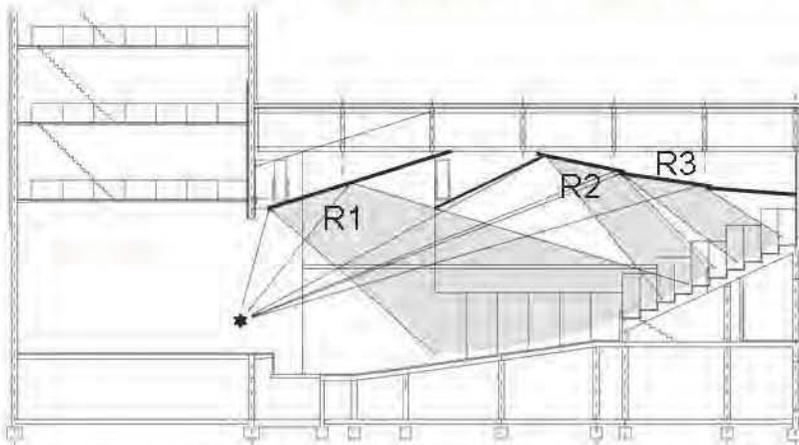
Falso techo generador de primeras reflexiones sobre la zona de público (sección longitudinal)
